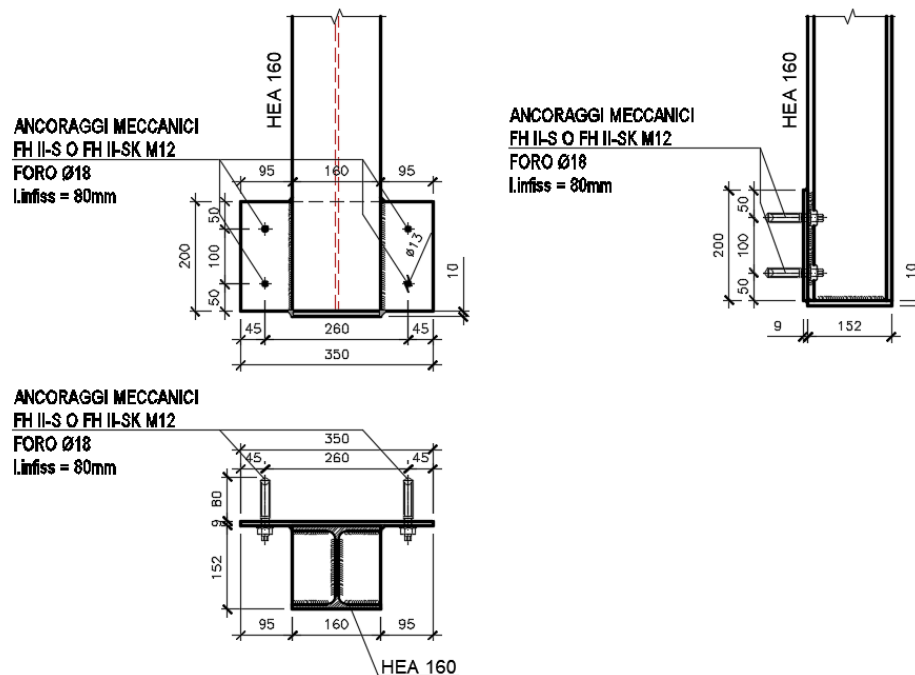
Dettaglio del collegamento superiore HEA160 barriera lato mare
